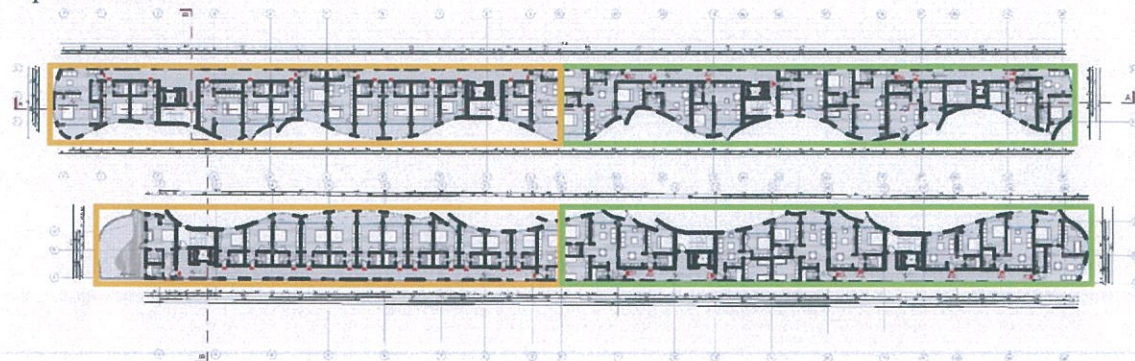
Planimetria e Katit të Dytë _HOTEL DHE APART - HOTEL
